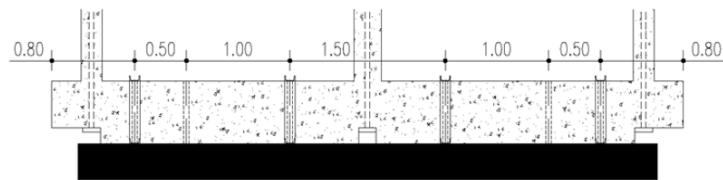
Ilustração do pré-esforço nos três pilares.
